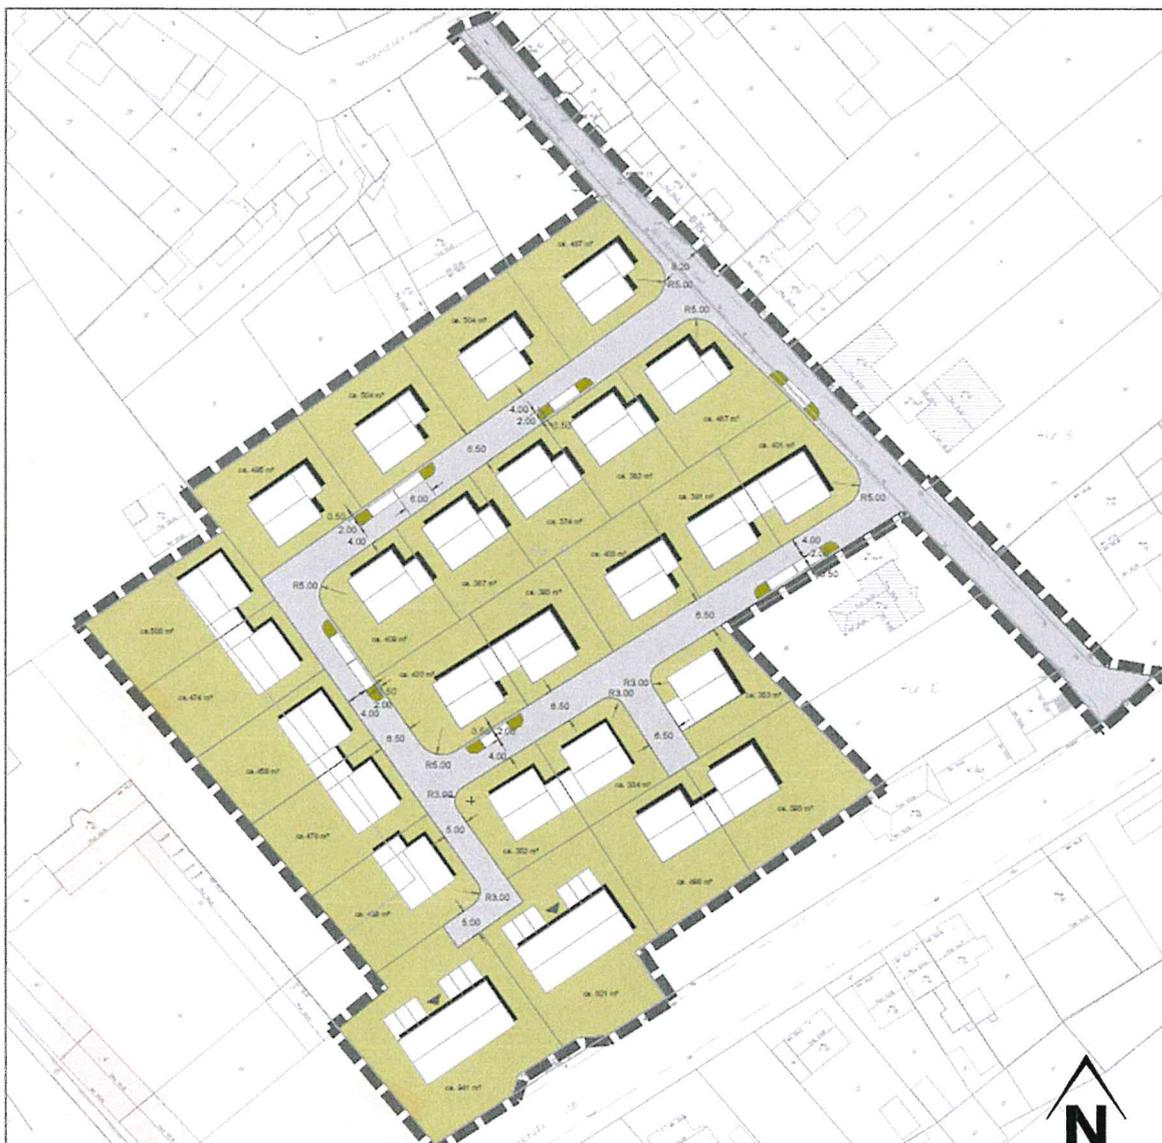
B-Plangebiet mit Ringstraße und geplanter Bebauung.
